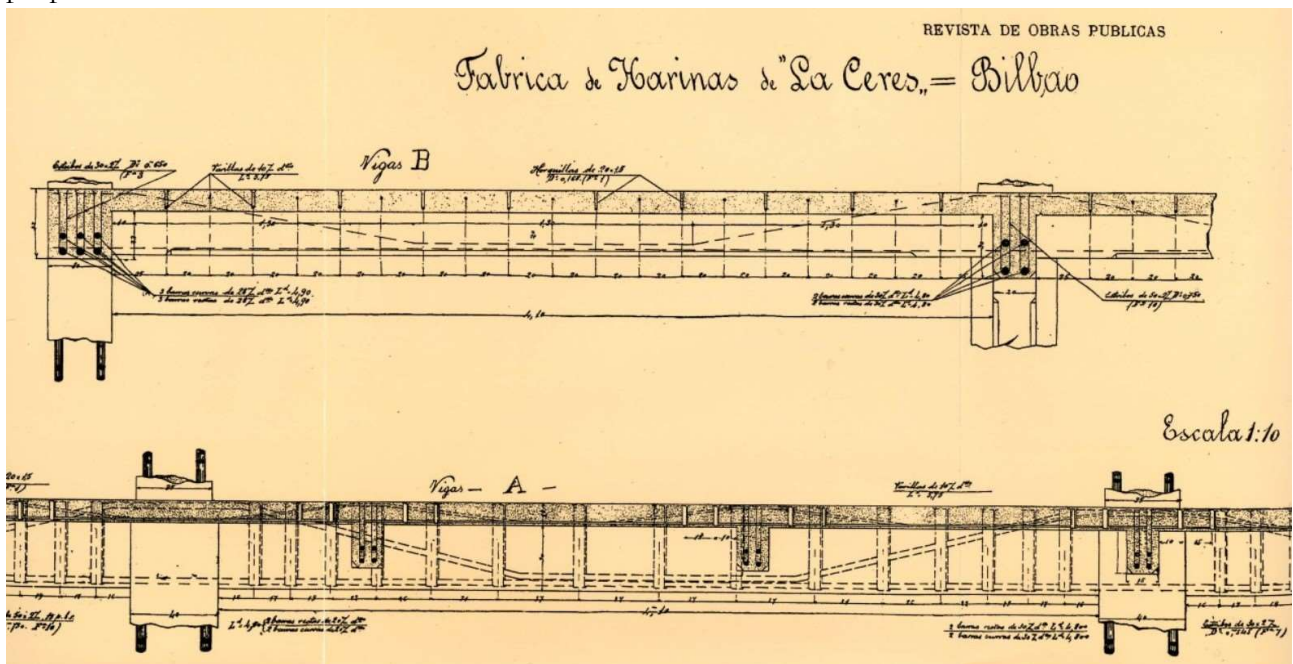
Plano con la disposición de la armadura en nervios y vigas, de otro edificio de la época, según este sistema patentado [2].
